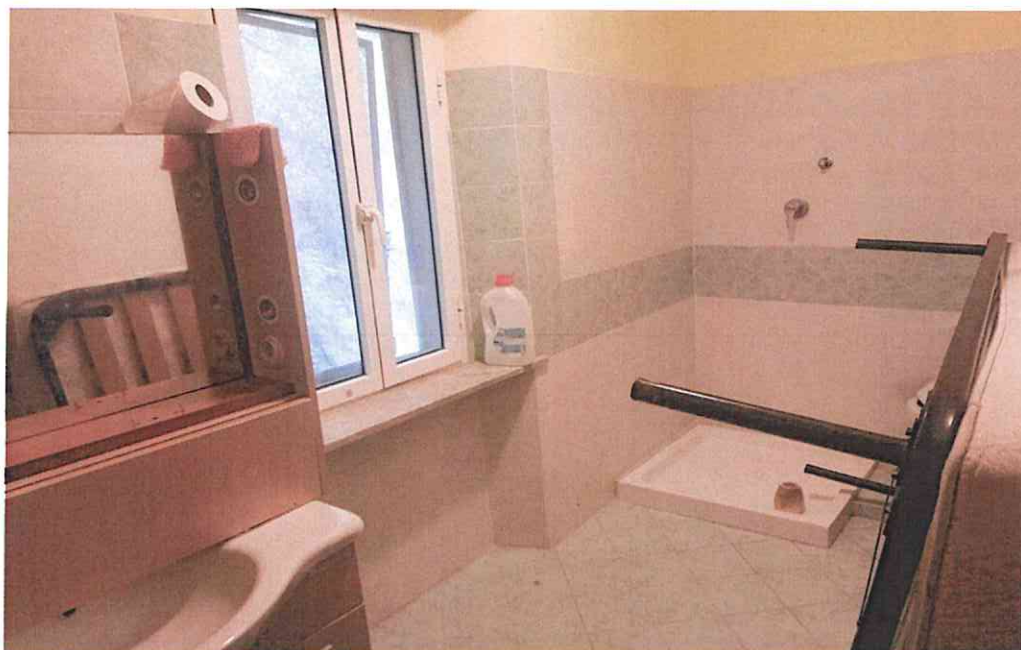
Foto interna – porzione bagno piano secondo lato sud accessibile dalla camera
